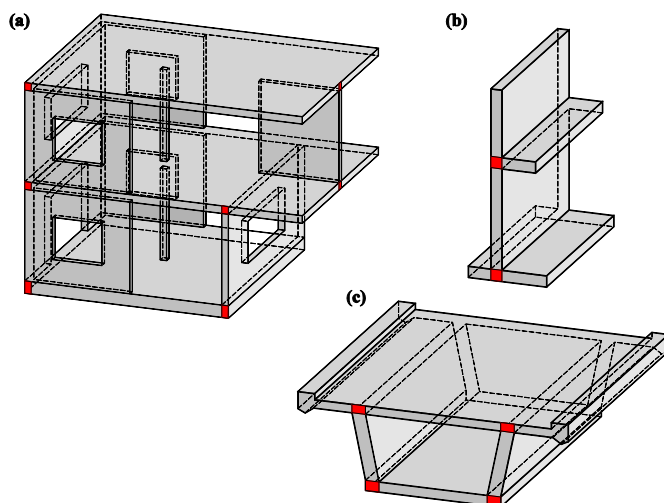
Beispiele von Rahmenecken (rot markiert) in Stahlbeton: (a) Typischer Hochbau; (b) Stützmauer; (c) Brückenträger.
